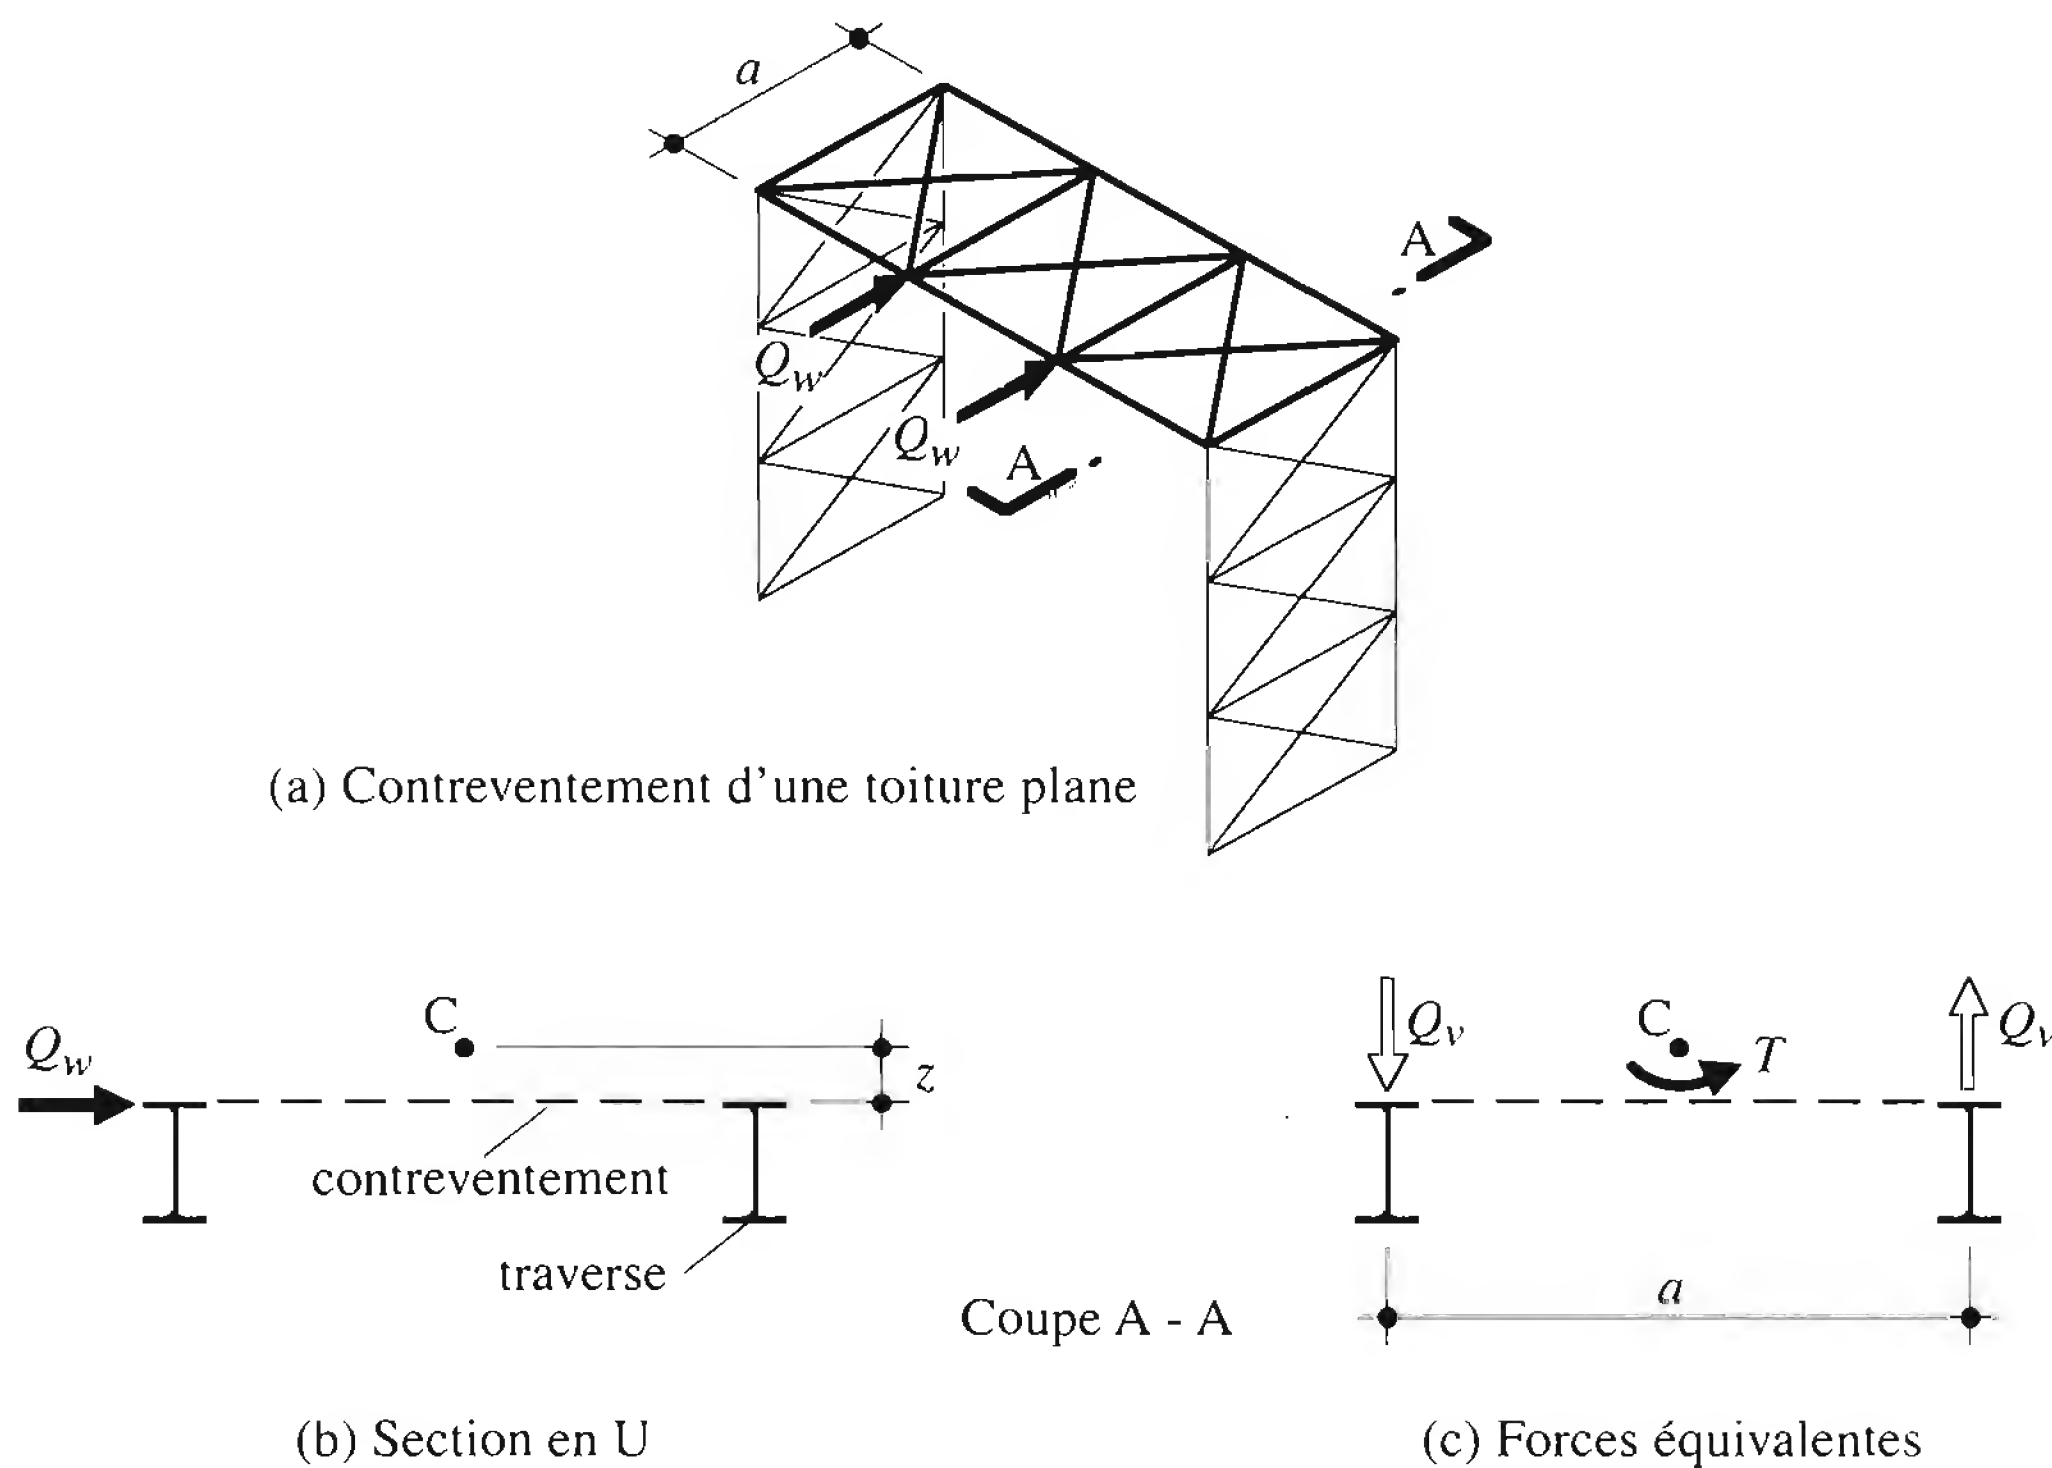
Sollicitations d'une section en U constituée du contreventement de toiture et de deux traverses.
